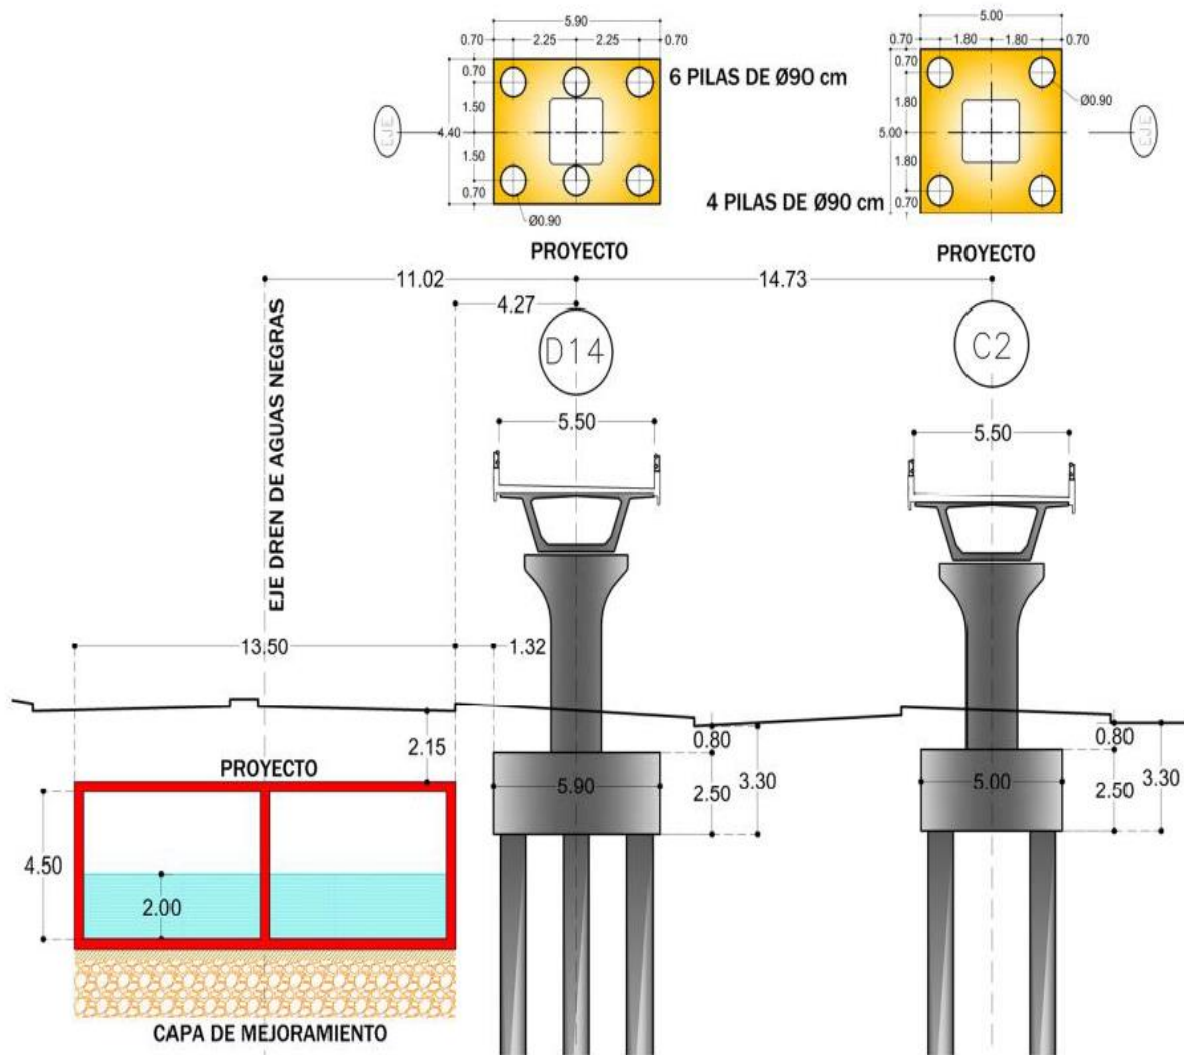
Diseño estructural inicial del encajonamiento del DAN en interacción de las gazas de insurgentes 070.
